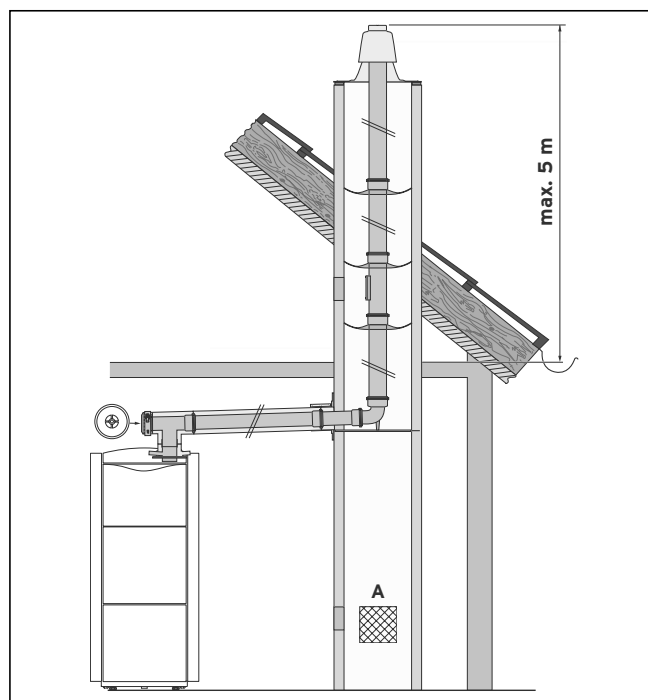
Пример монтажа с забором воздуха из помещения
